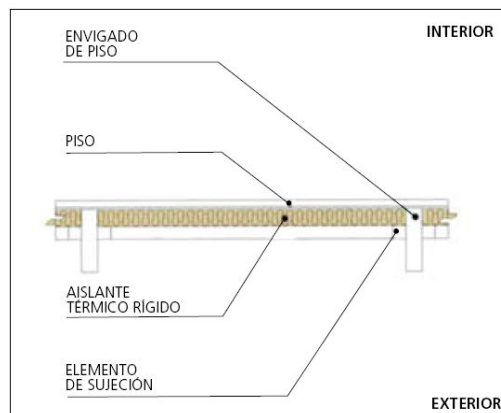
Piso con vigas y aislante térmico adosado en cara exterior⁽²¹⁾.
